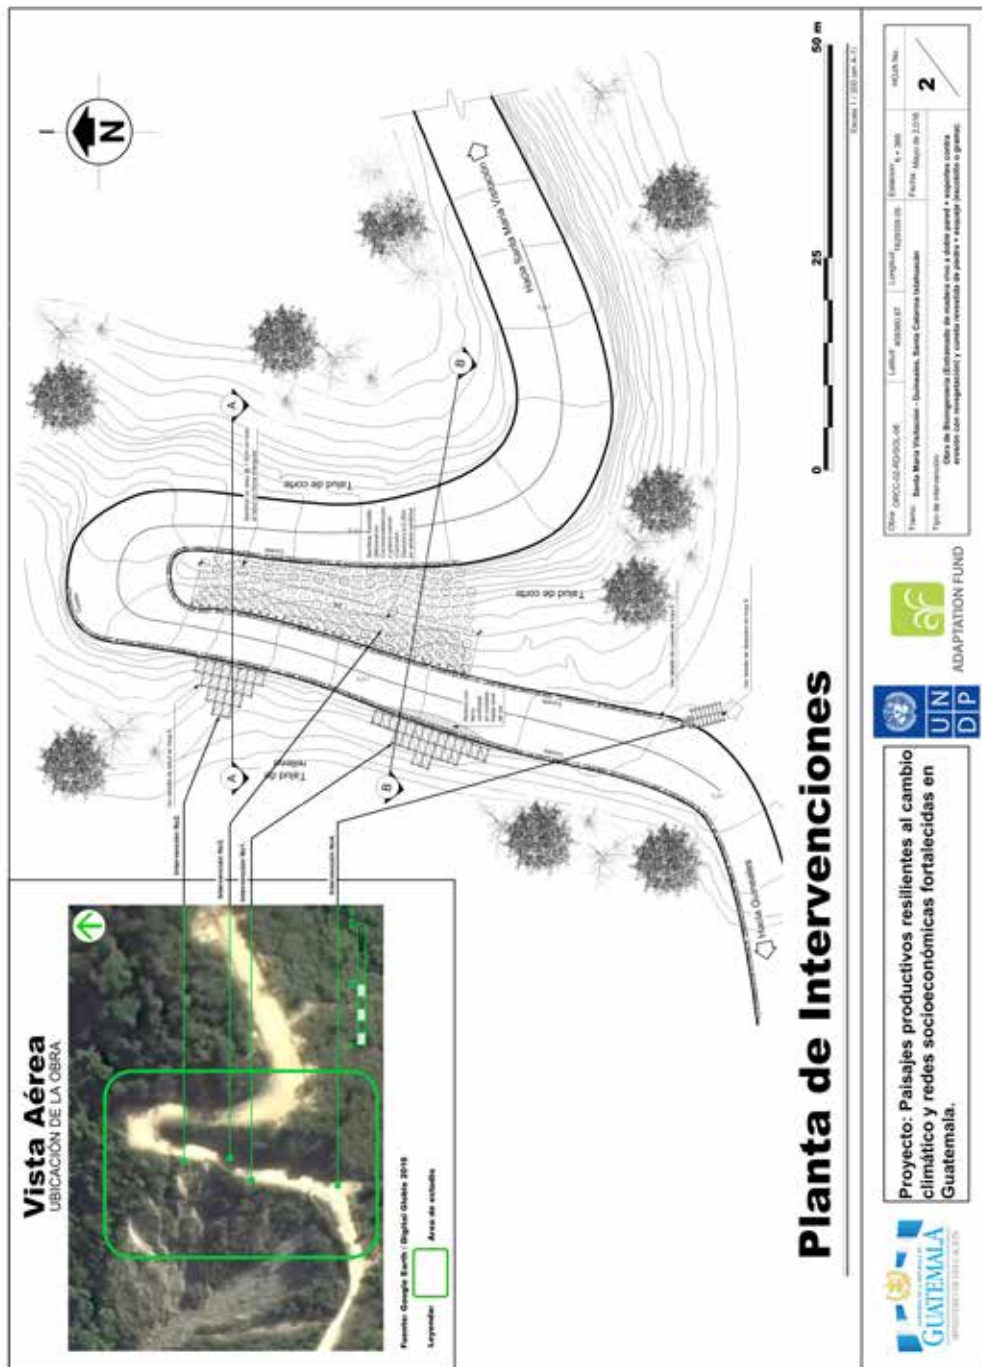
A. PLANTA DE INTERVENCIÓN. Planificación Obra ORCC-02/RD-SOL-08. Tramo: (Santa María Visitación-Guineales, Sta. Catarina Ixtahuacán)
